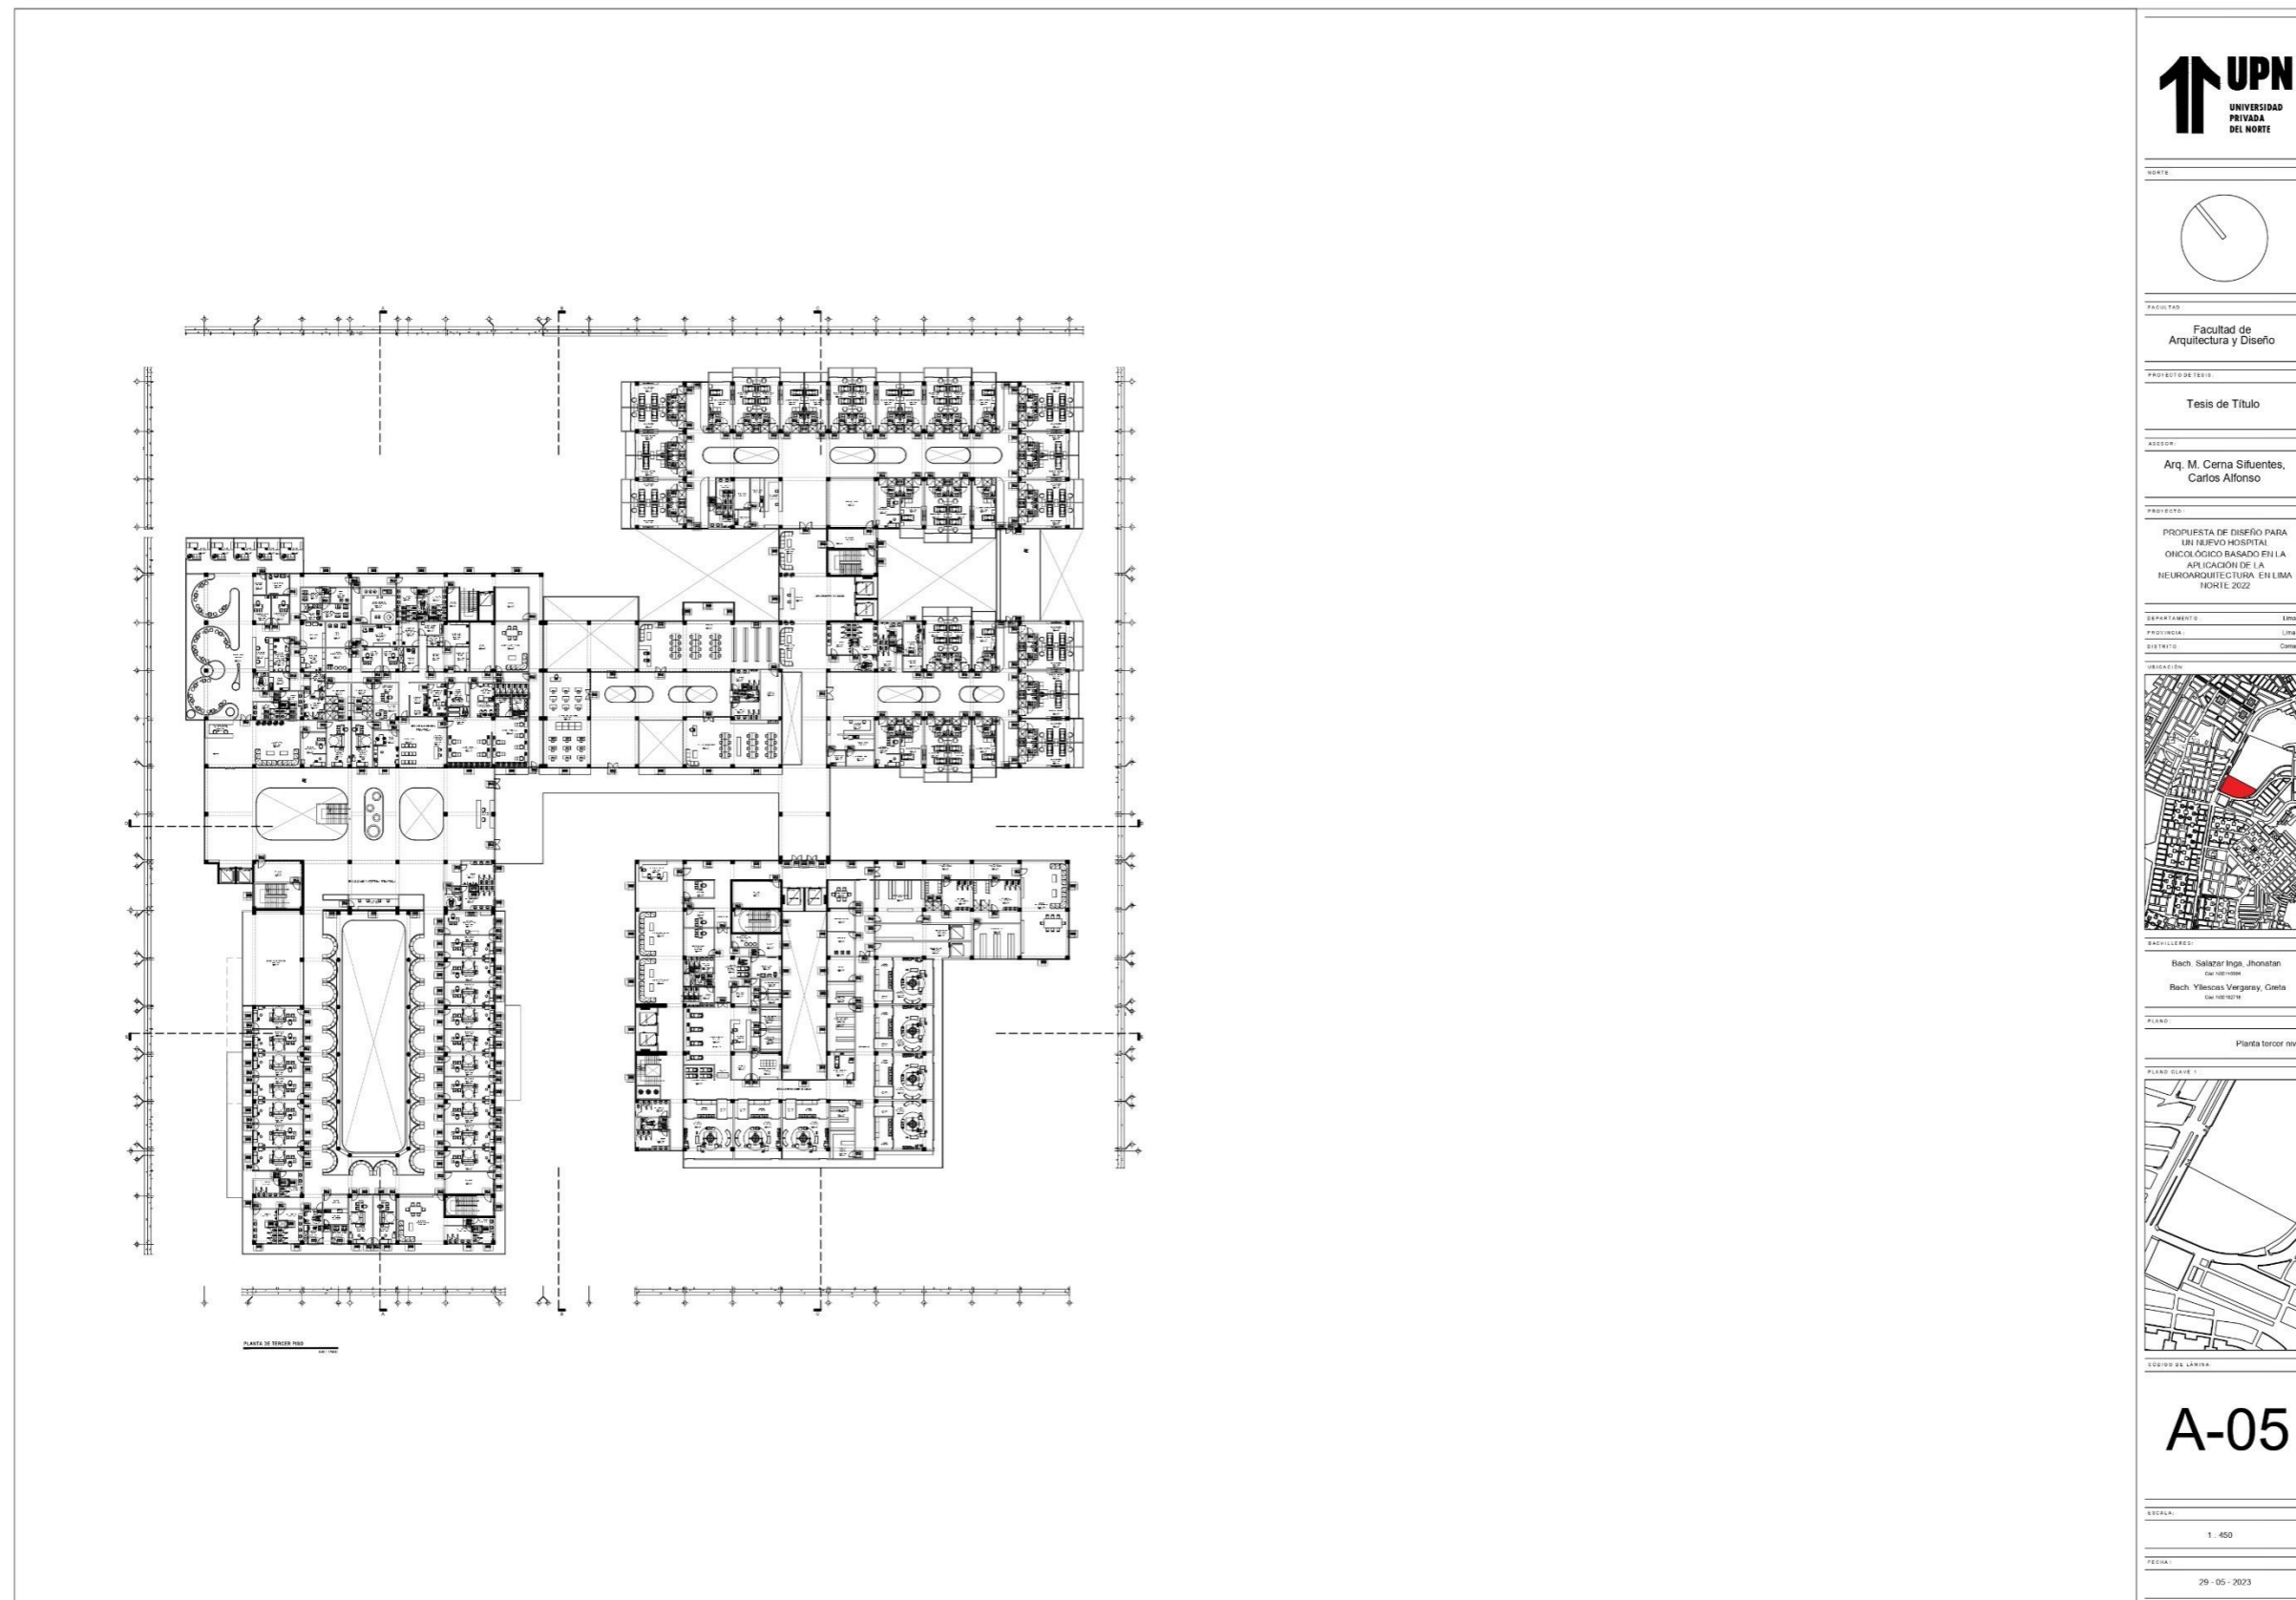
Arquitectura – Planta nivel N°2 Esc: 1/450 (Fuente: Elaboración propia de los coautores)
